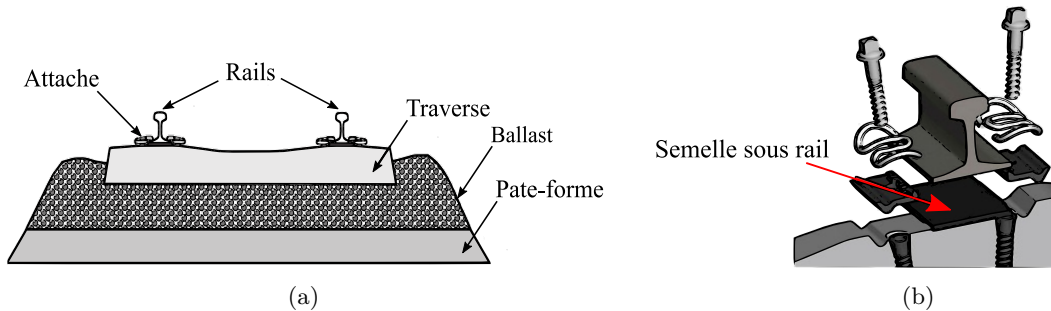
(a) Section transversale d'une voie ferrée; (b) Système d'attache du rail sur la traverse.
